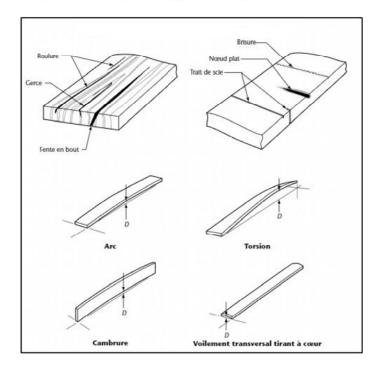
Défauts dans les madriers Source : Groupe CSA
